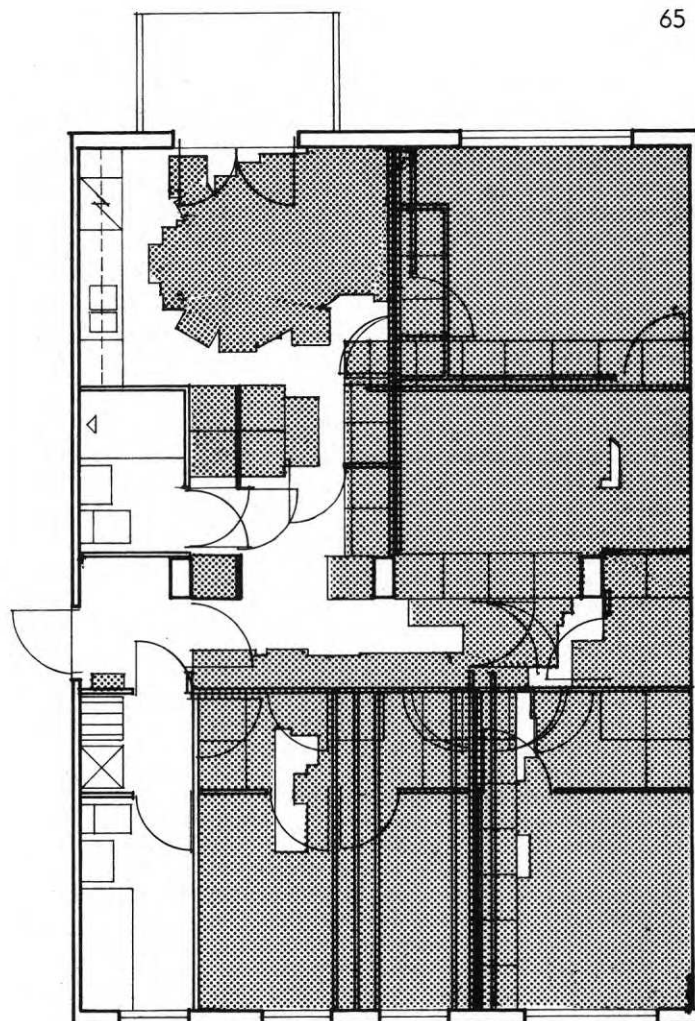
Sammanställning av planerna 13A-16C summa 9 planer var-av ett möbleringsalternativ.
